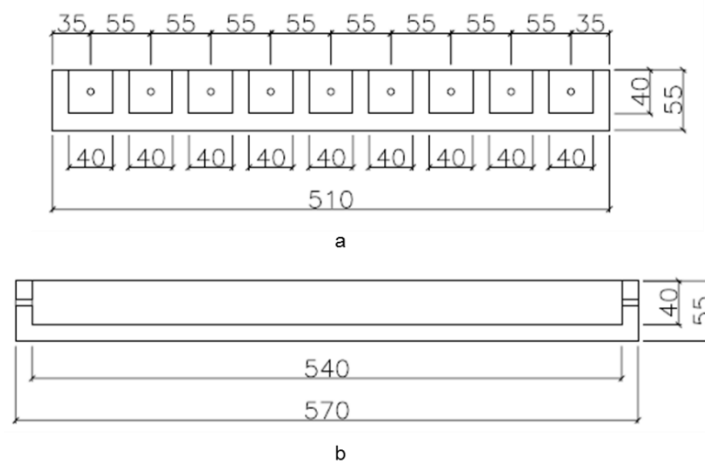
Detalhes da fôrma para tirantes para o CA-25, com dimensões em mm: (a) corte A-A'; (b) corte B-B'.
